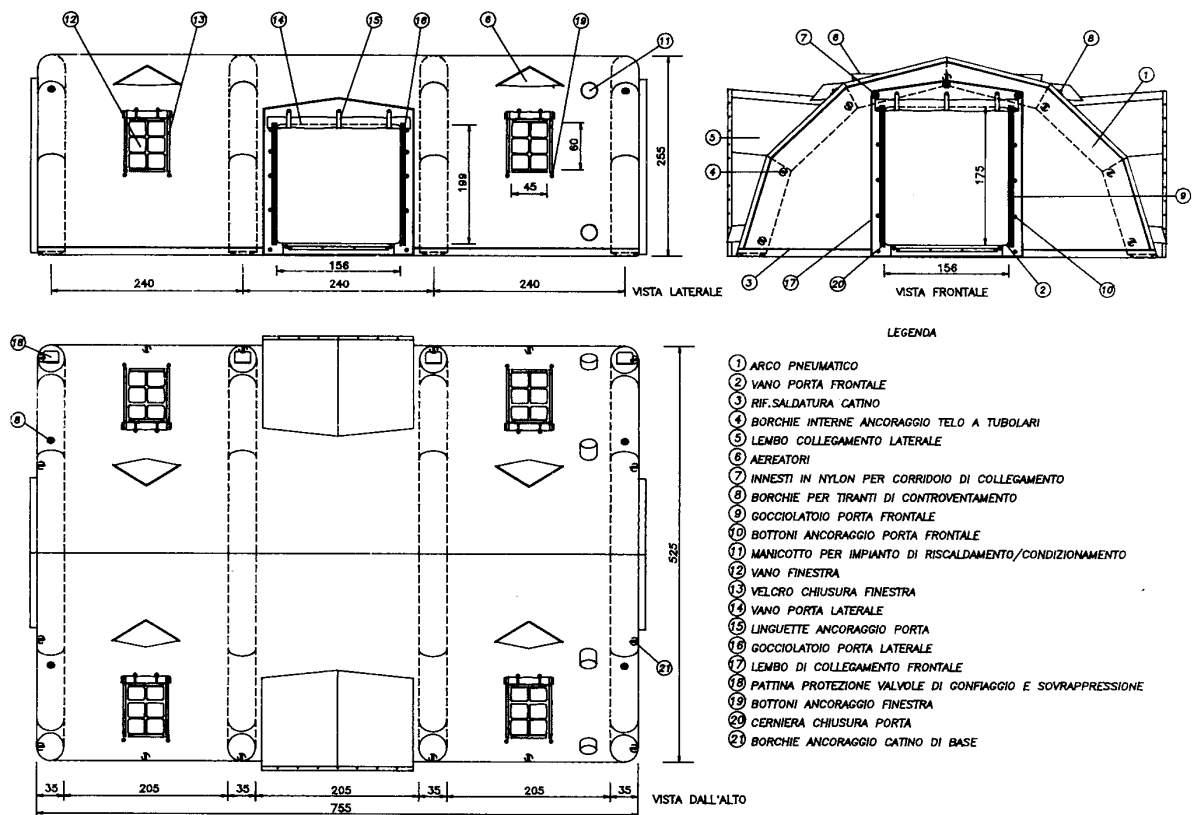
Tenda 4 archi - 4 porte vista laterale, frontale e dall'alto.
